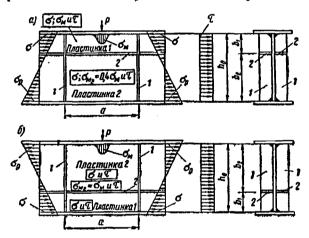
Схема балки, укрепленной поперечными основными ребрами (1) и одним продольным ребром жесткости (2)
